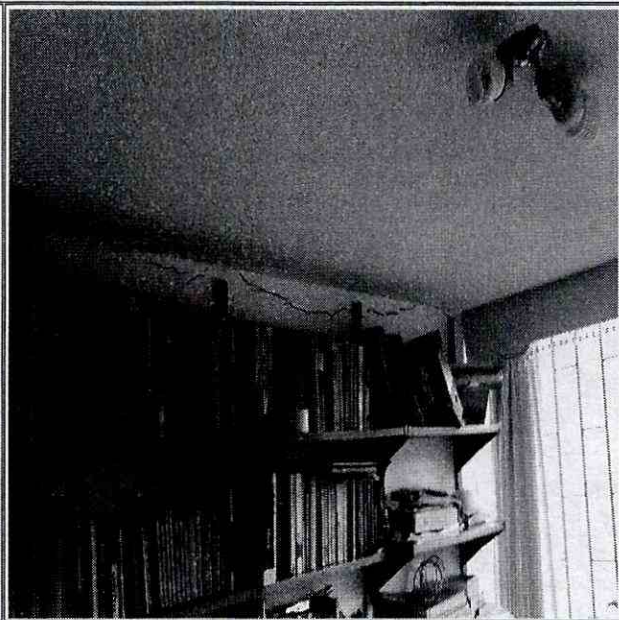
Grietas muro divisorio segundo nivel de la vivienda
